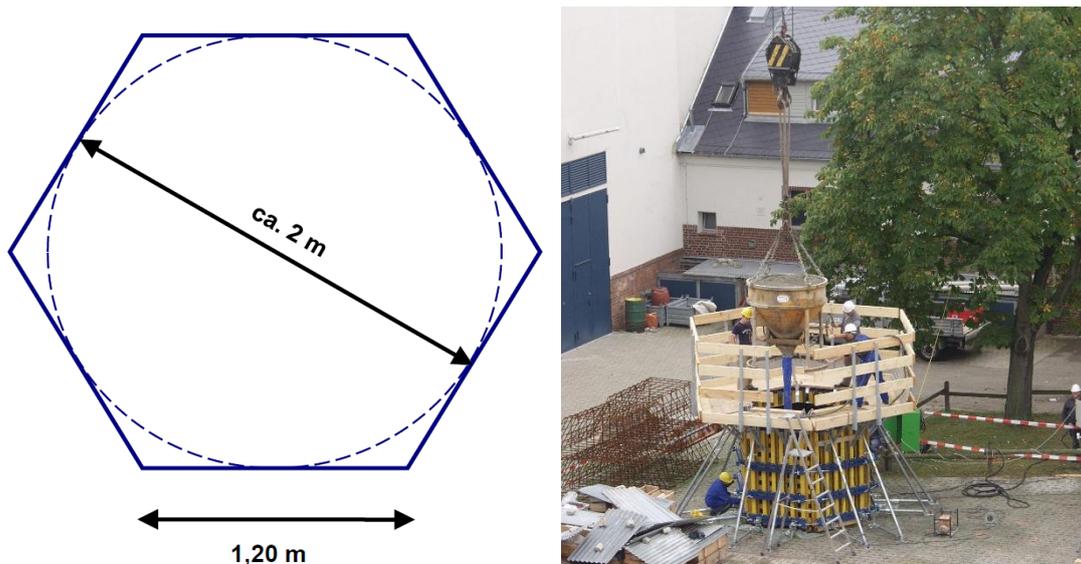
Abmessungen der Probblöcke und Herstellung mit Betonierkübel
